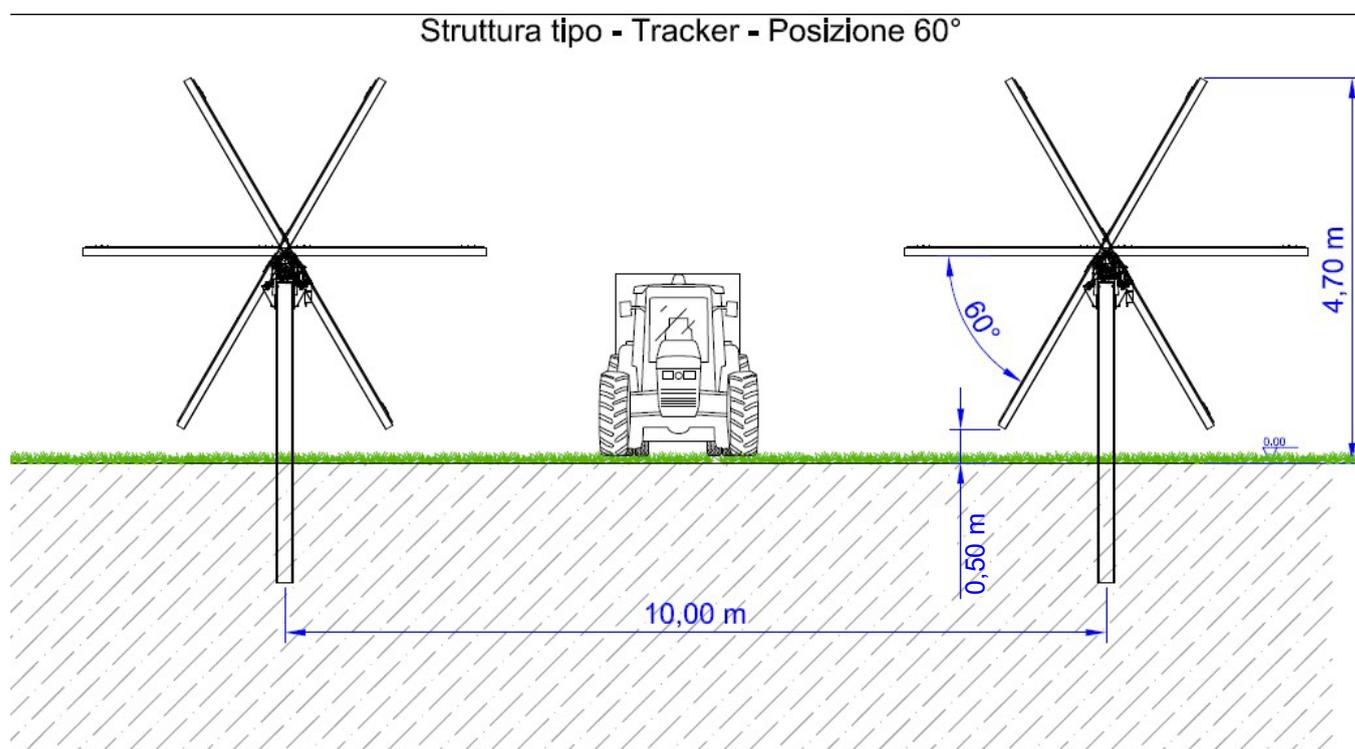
Tipico struttura di supporto – Vista posizione 60°
